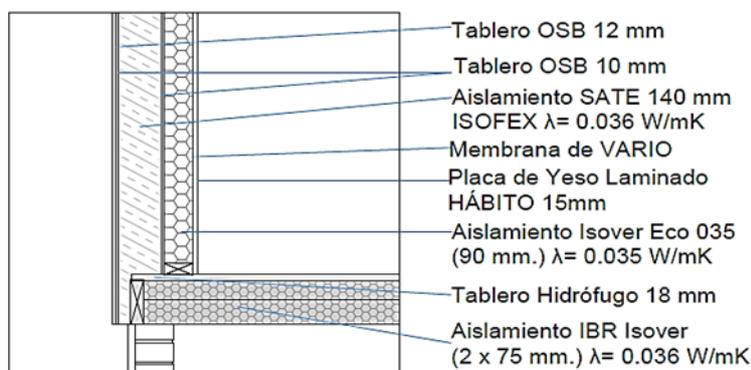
(b): Encuentro fachada – solera vivienda ABS.
